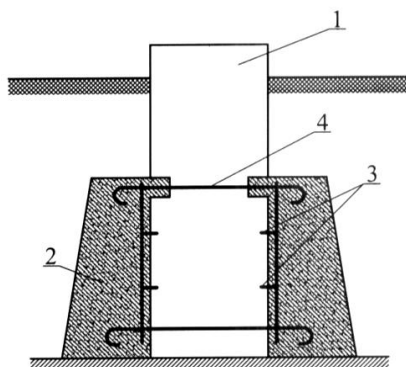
Усиление ленточного фундамента с помощью железобетонной обоймы:
